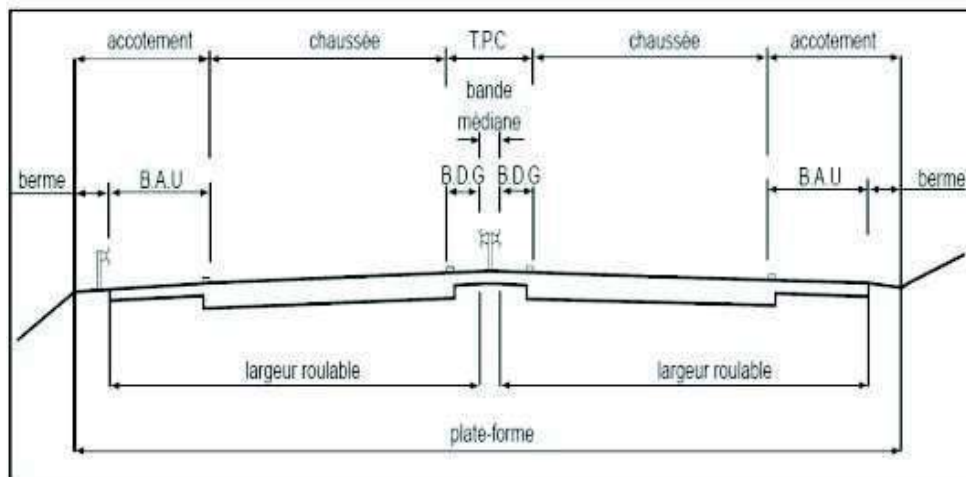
Eléments constitutifs du profil en travers en section courante.
